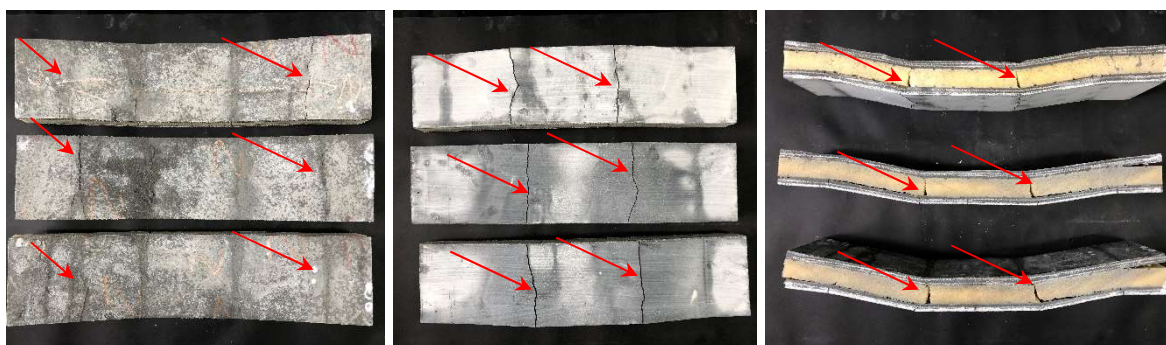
Fissuras no núcleo do Painel Sanduiche.
